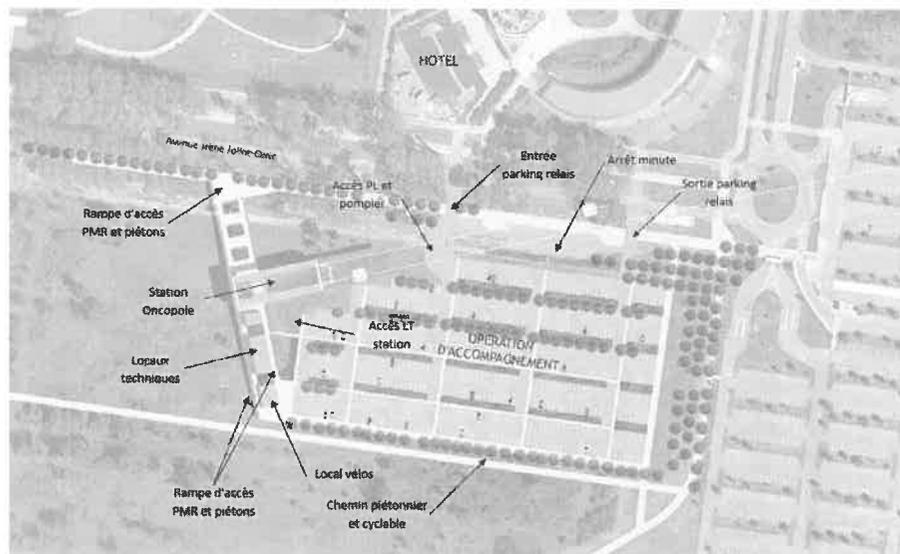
Plan d'aménagement de la station Oncopole et de son parking relais (source : Groupement POMA, 2018)
